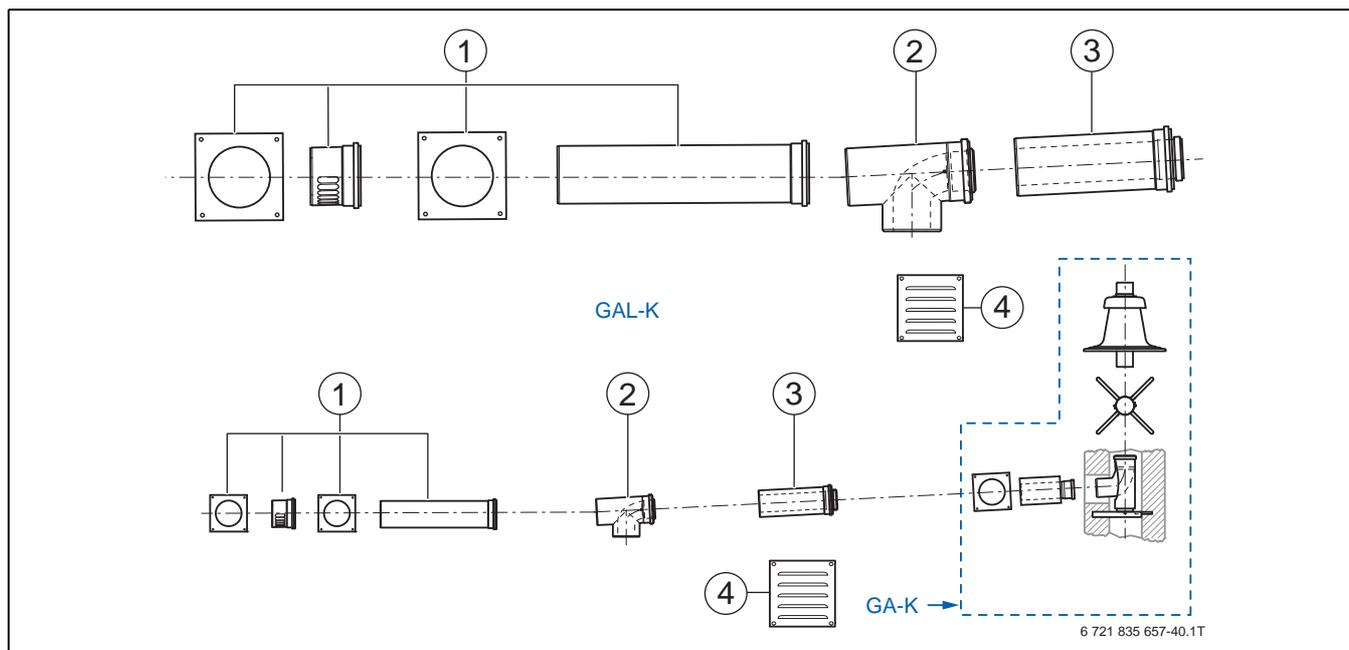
Bauteile des Grundbausatzes GAL-K aus Kunststoff
